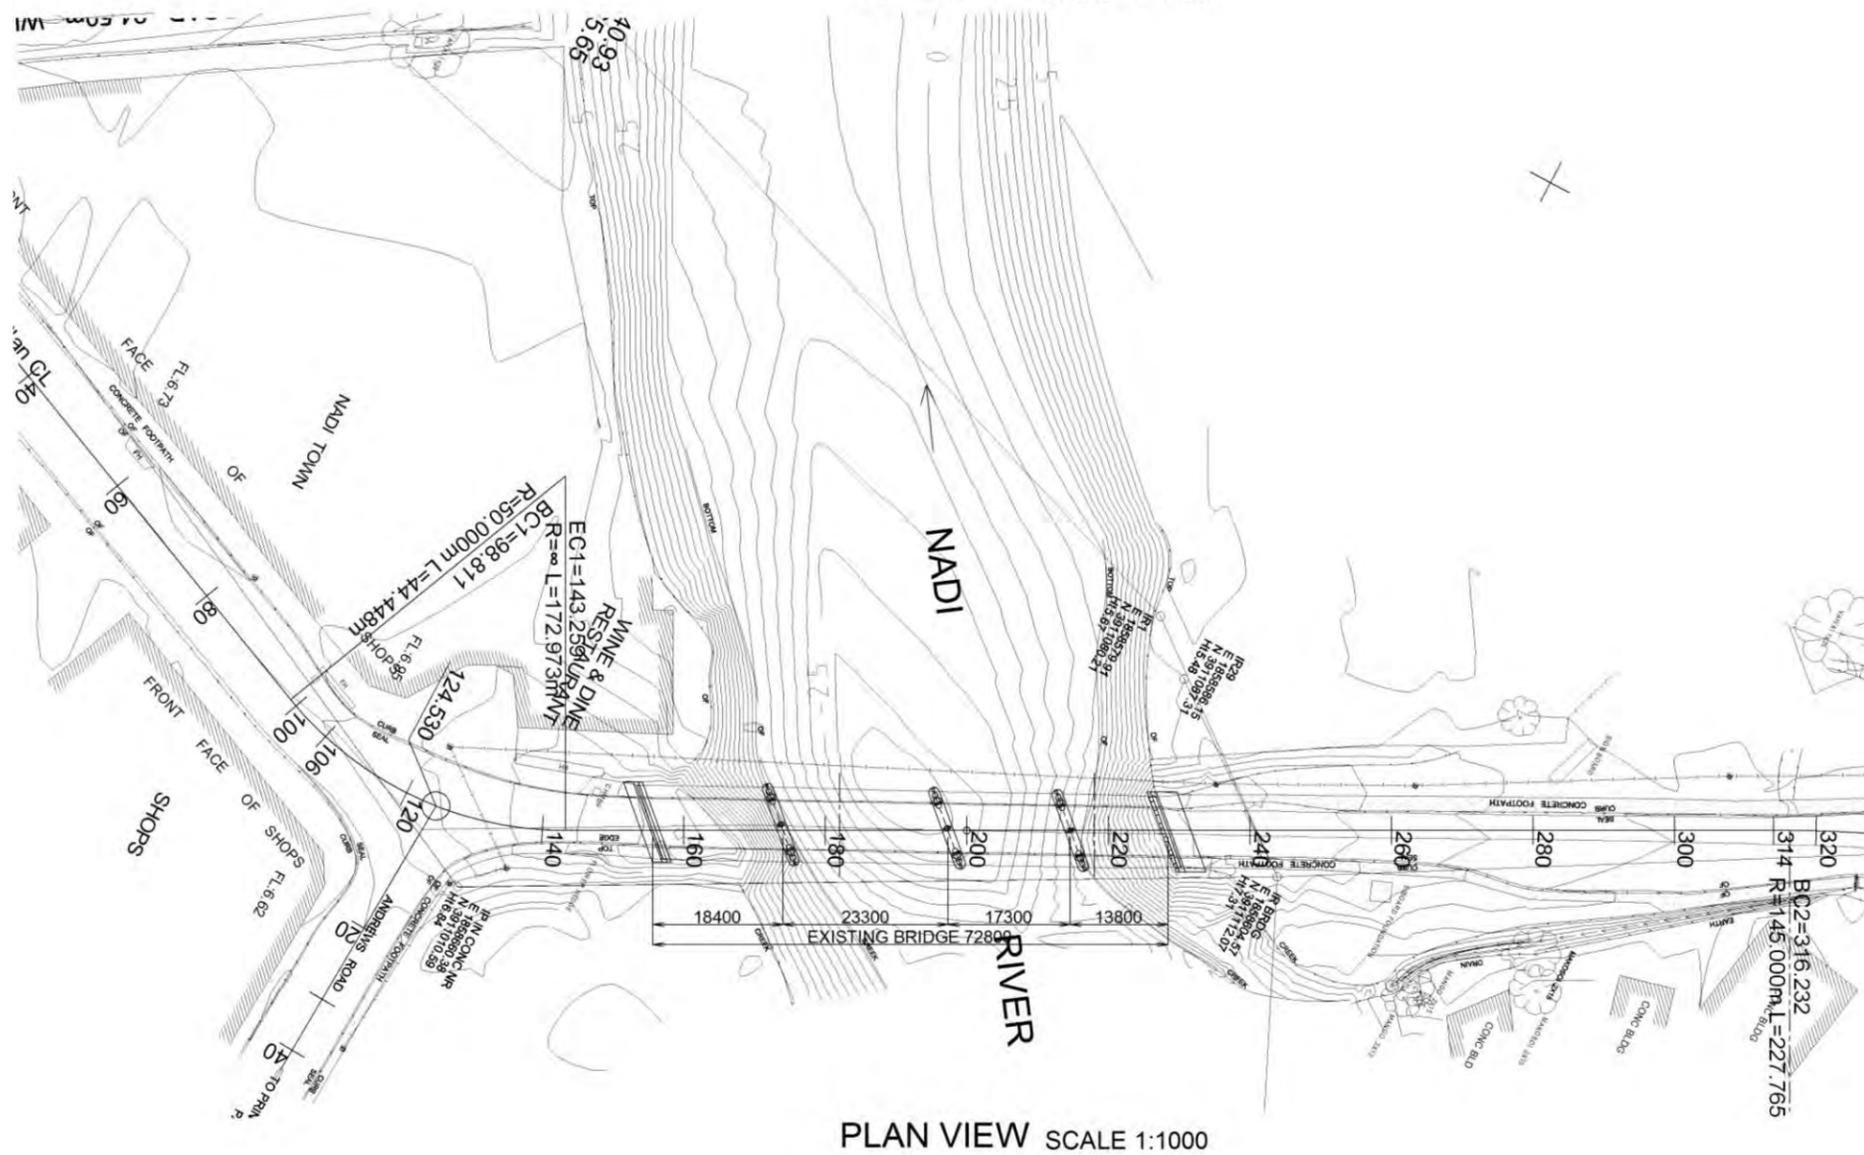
既設橋梁一般図 (Nadi Town Bridge)
